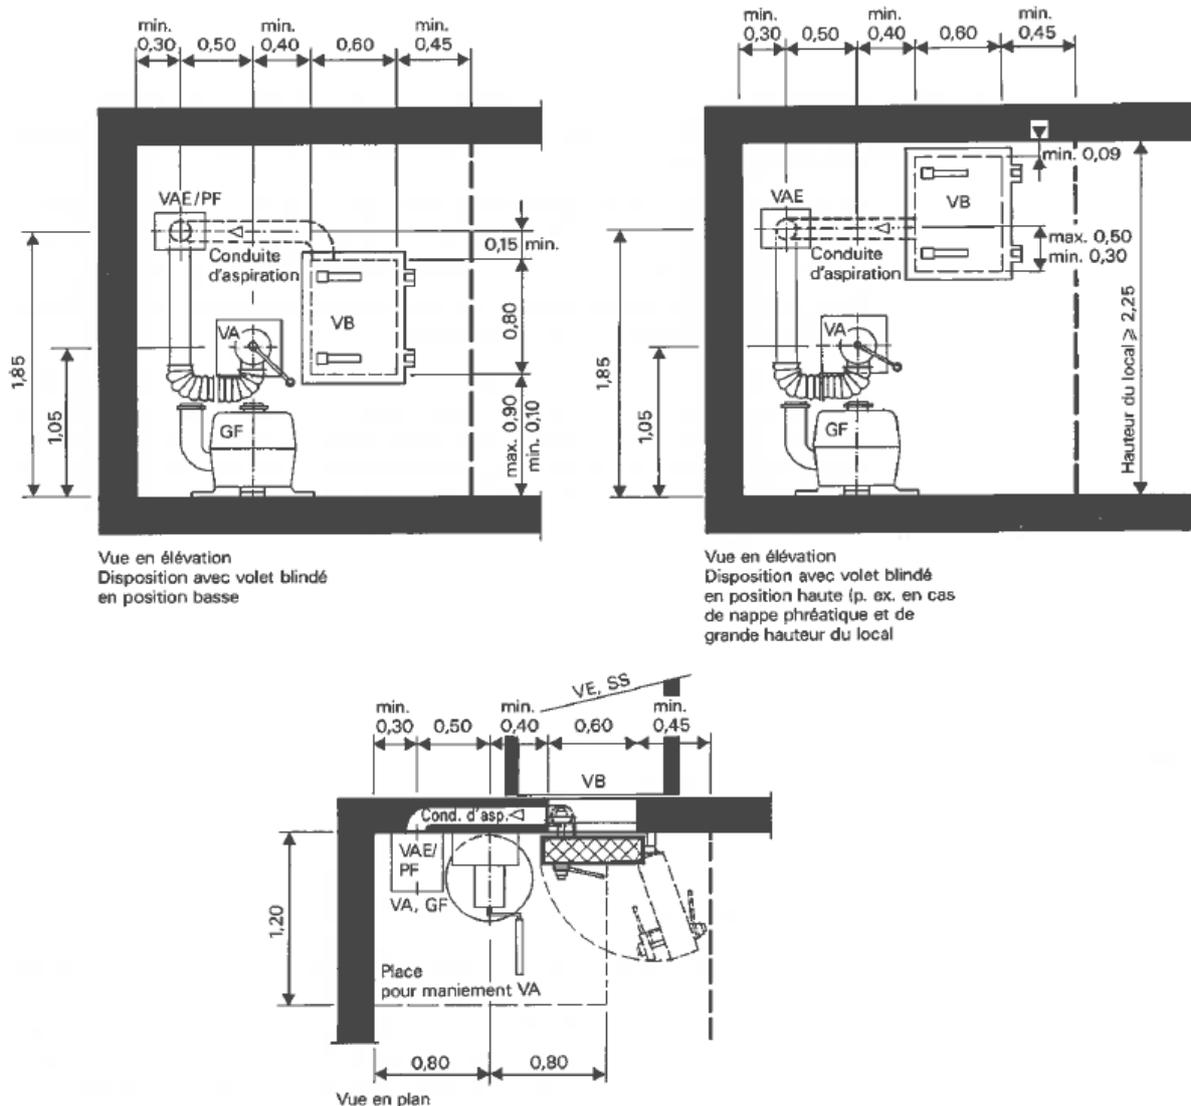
Disposition de VA et VB le long d'un mur
